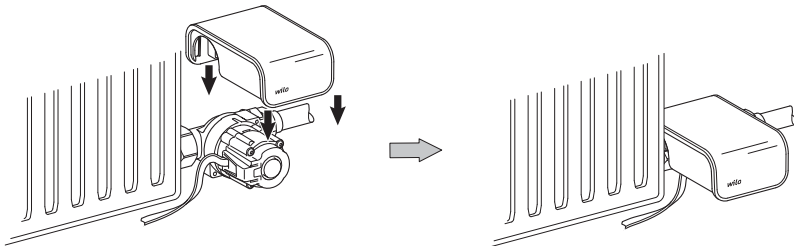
Verkleidung auf Heatfixx Pumpe/Pumpenadapter aufstecken
